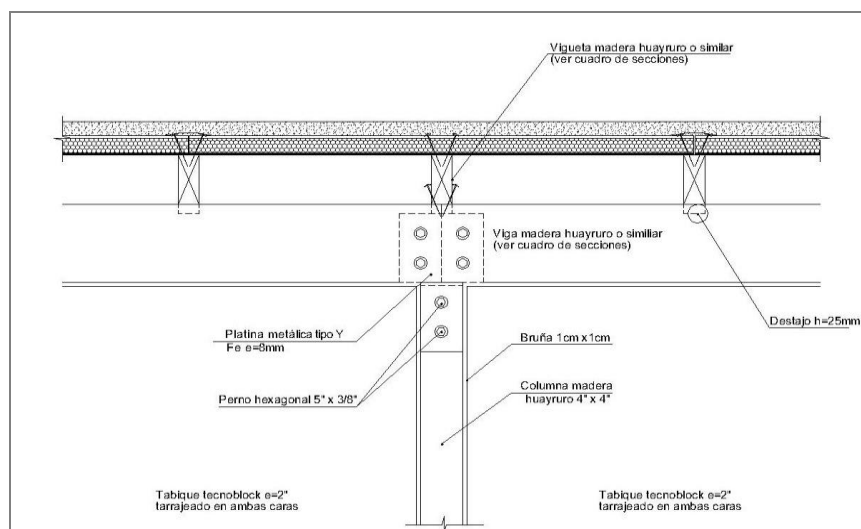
Detalle de fijación con platina de vigas intermedias y columna
